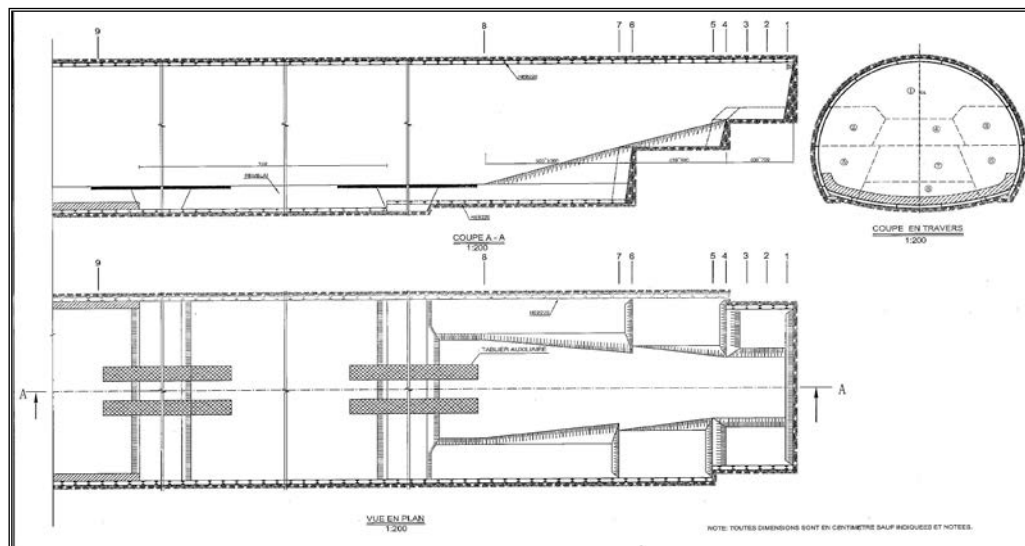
Vue en plan et en coupes longitudinale et transversale des différentes phases d'excavation en section divisée
